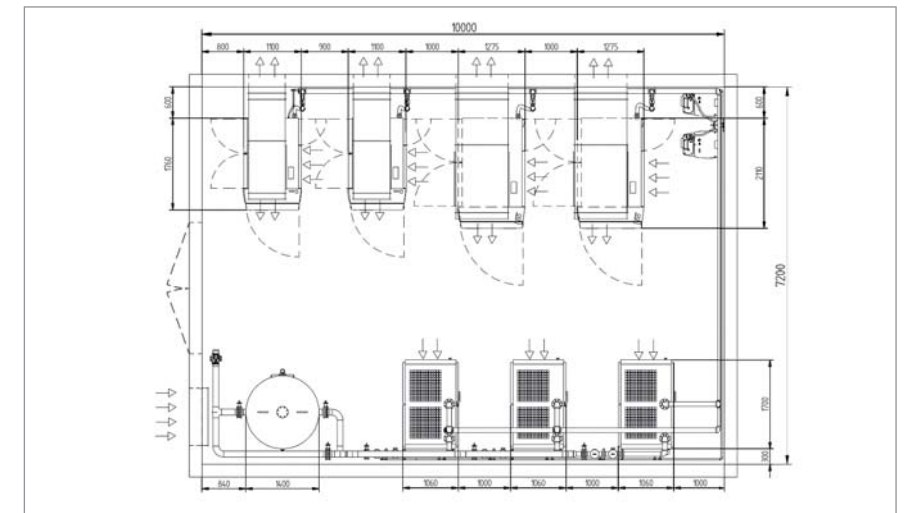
Plan d'ensemble d'une station d'air comprimé
